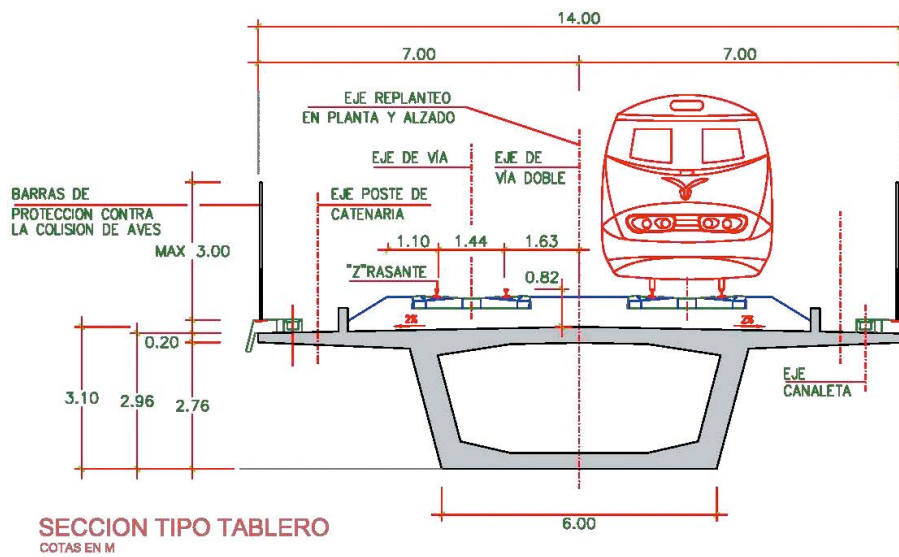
Sección transversal tipo del tablero de los vanos de acceso del viaducto de Almonte.
